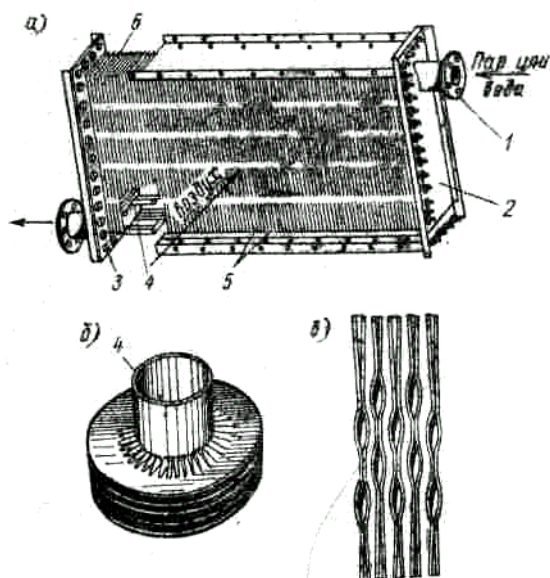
Внешний вид и детали калорифера: б - ленточная навивка; в - деталь ленточного калорифера Кравцова; 1 - левое (на воде) присоединительный штуцер; 2 - крышка; 3 - трубная доска
